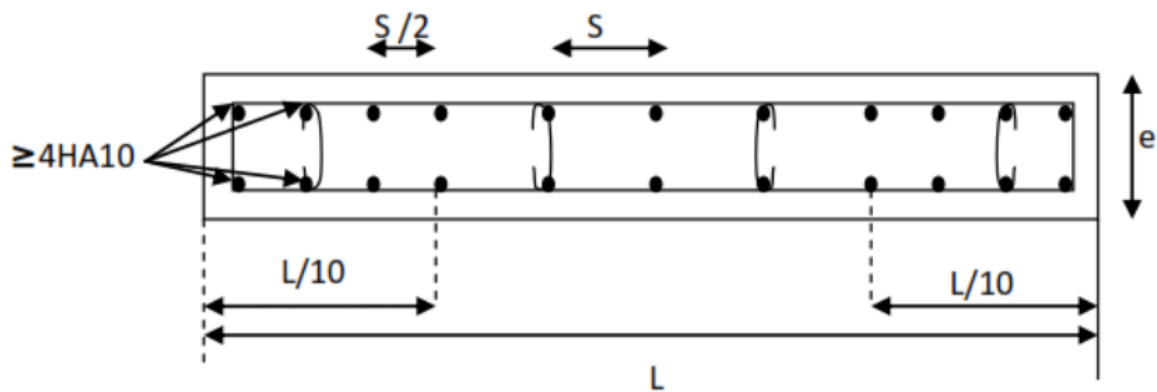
Disposition des armatures verticales dans les voiles.
